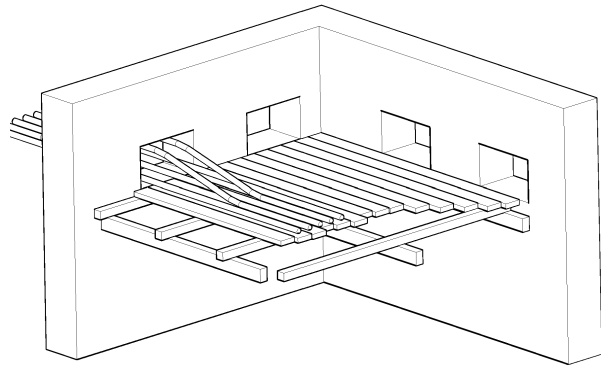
Verbindung der Deckenkonstruktion mit den gegliederten Wände [nach 1.4]
